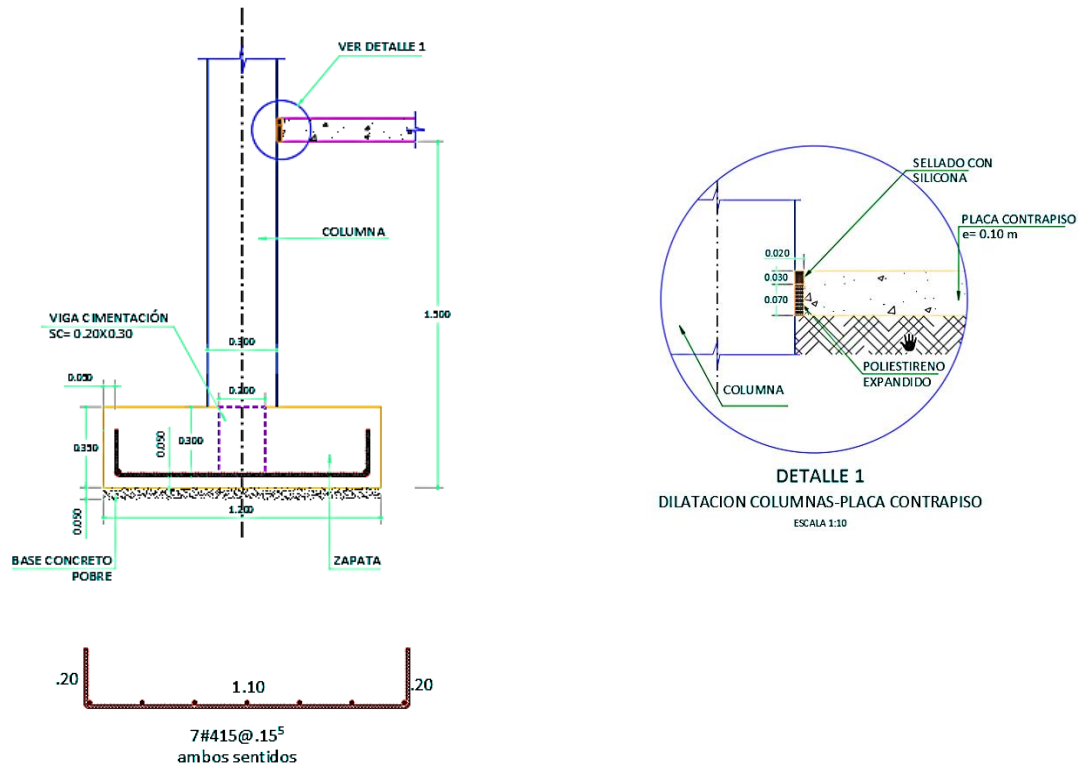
Detalle alzado zapata 1 y detalle 1. Fuente Estudios y diseños contrato 1318-2013
